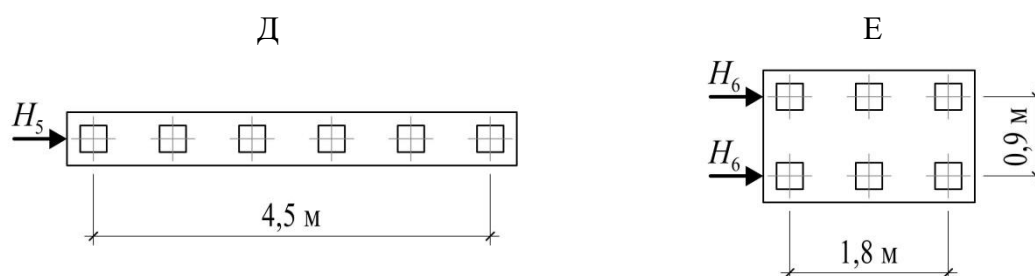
Схемы горизонтально нагруженных фундаментов: Д – ряд из 6 свай; Е – группа из 6 свай
